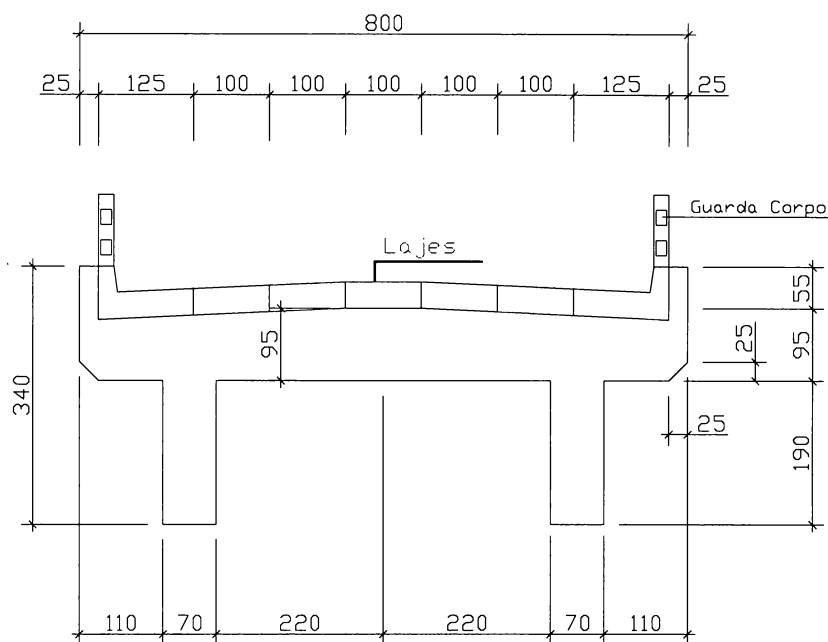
ANEXO – LAJES DA PONTE 8 FONTE: Extraído do projeto executivo
